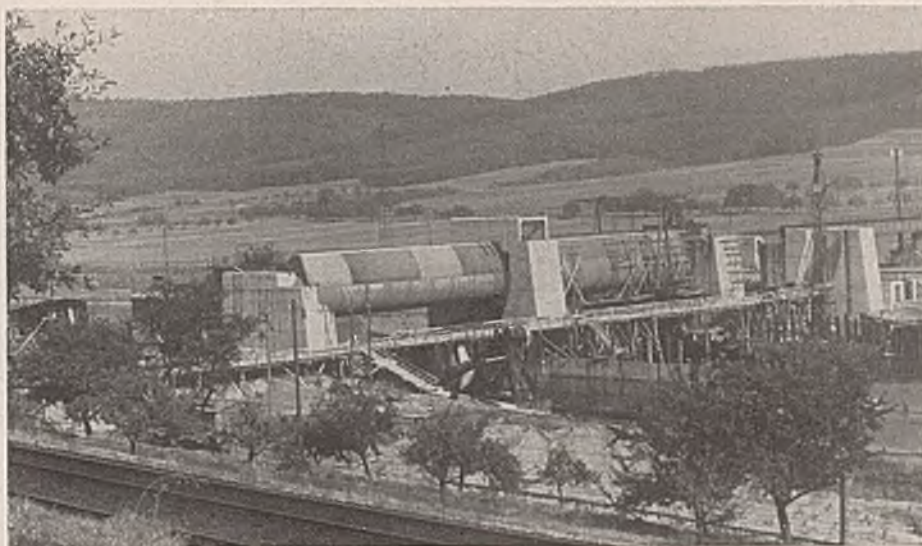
Staustufe Steinbach. Blick auf die Wehrbaustelle.
